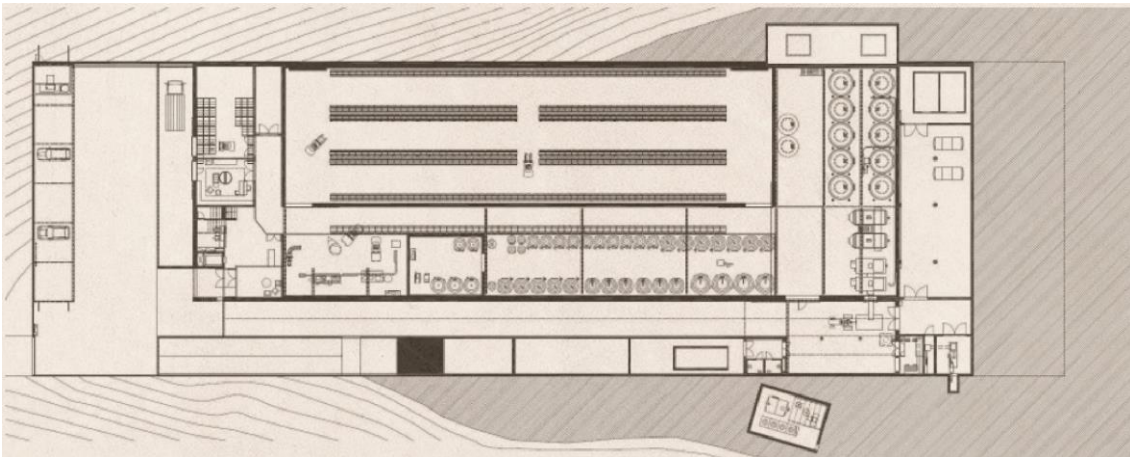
Planta do piso o da adega Mayor ²³⁵
